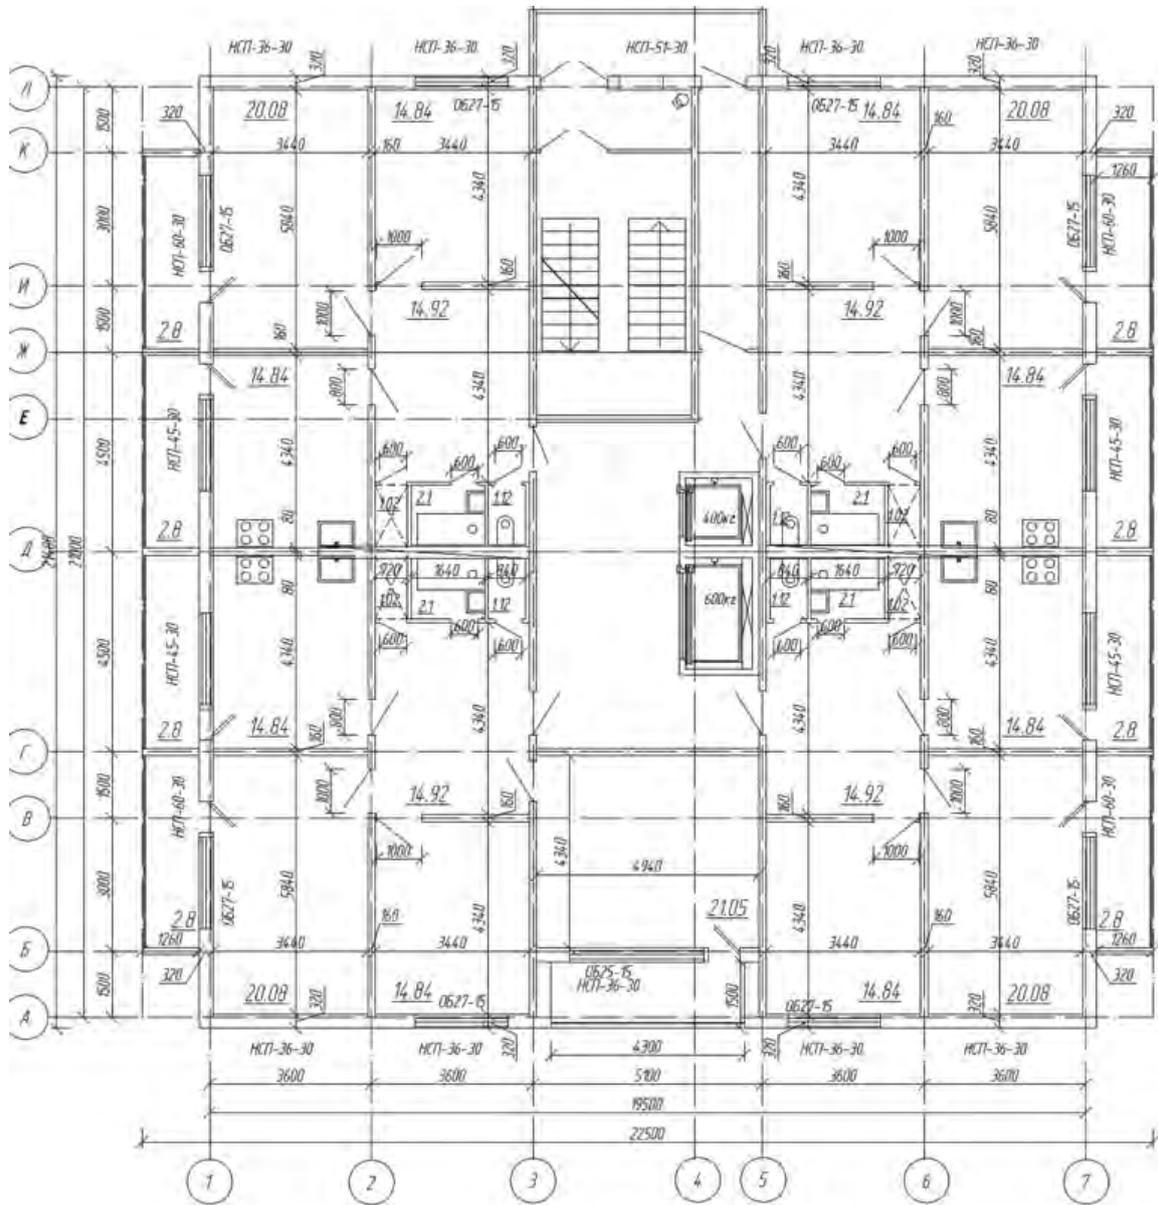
Точечная планировочная схема (односекционная). План типового этажа с незадымляемой лестничной клеткой (при количестве этажей более 9)
